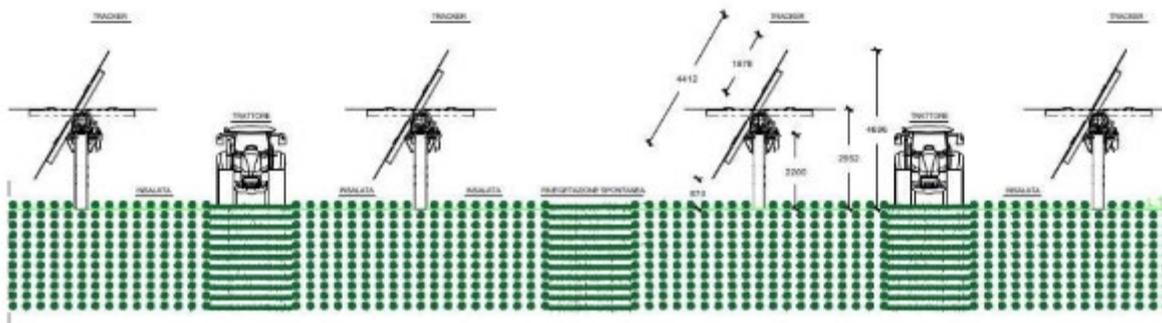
Veduta prospettica frontale dell'impianto agrovoltaico
